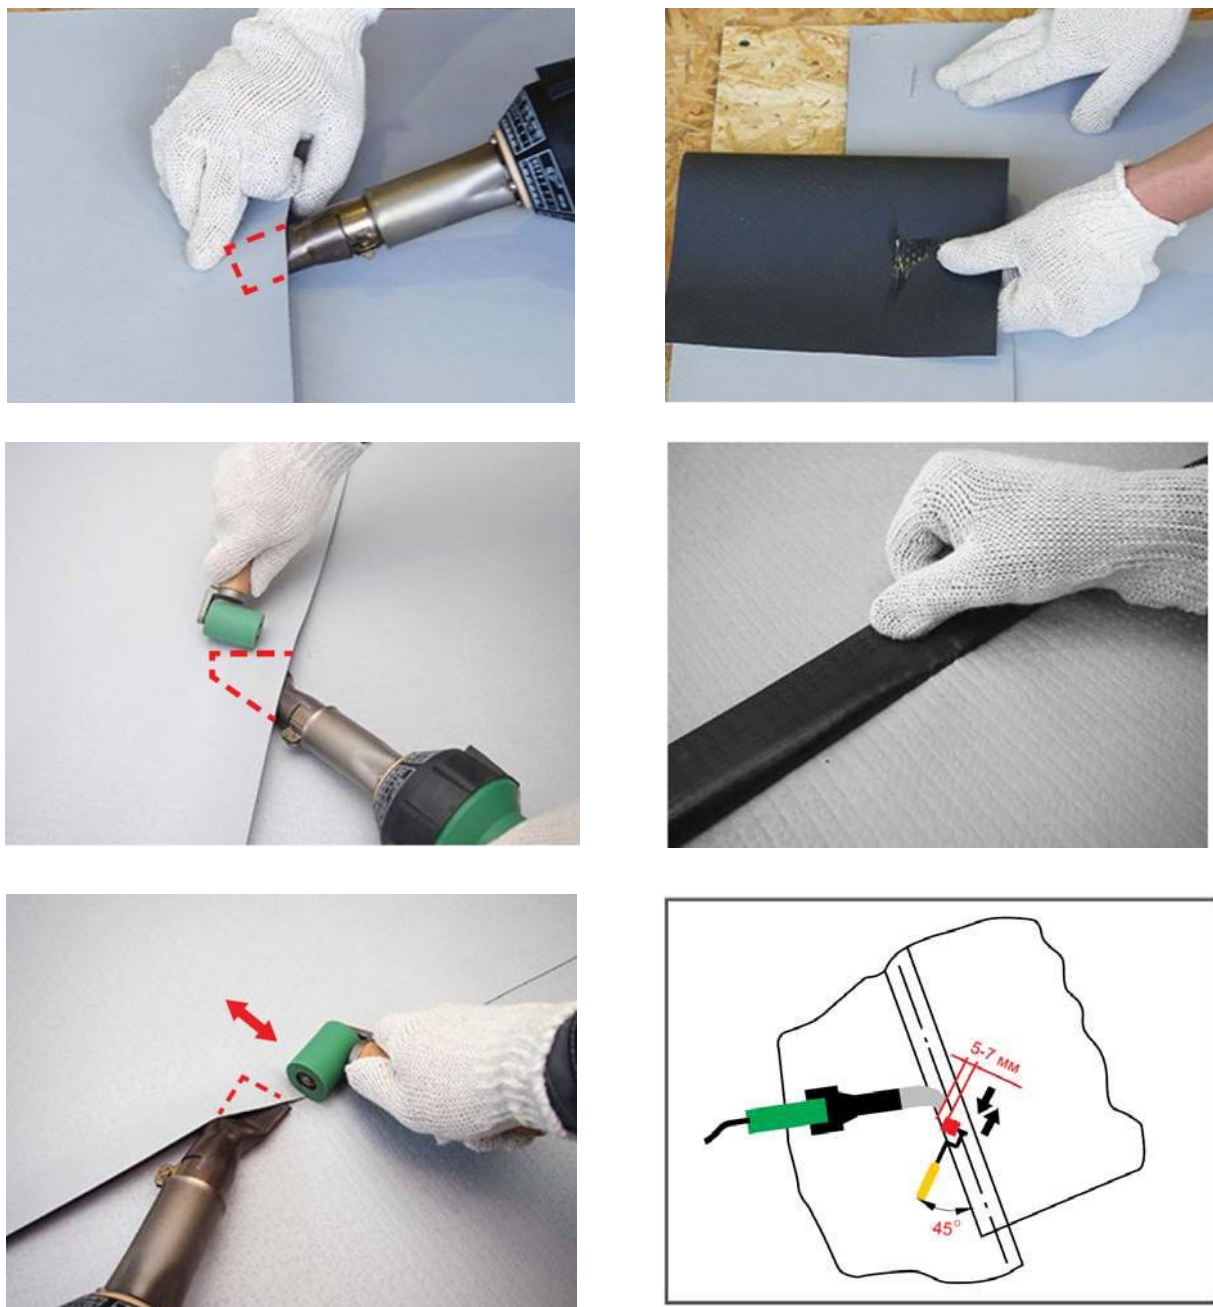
Доваривание шва при помощи ручного сварочного оборудования
